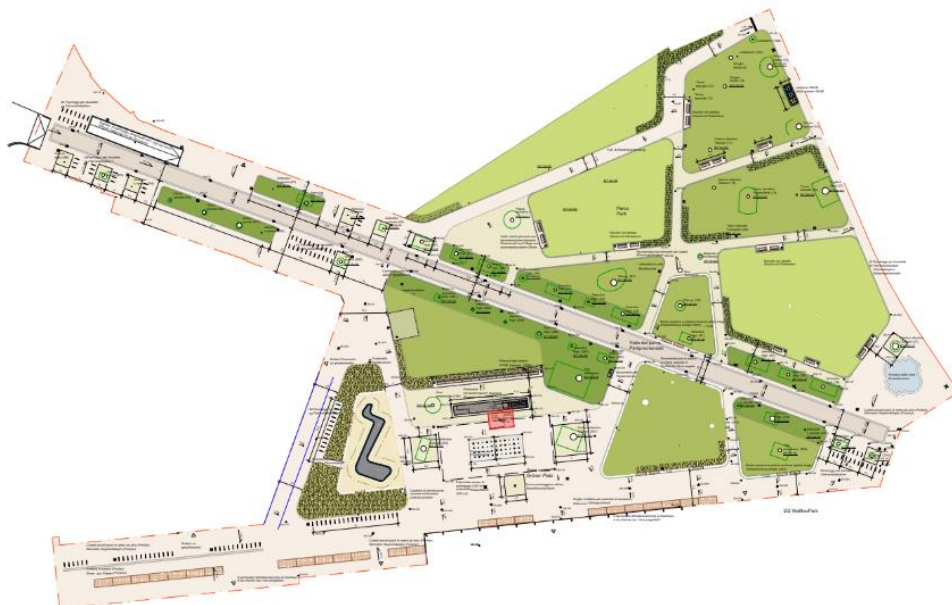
Grundriss. Der Technikraum ist rot markiert.
